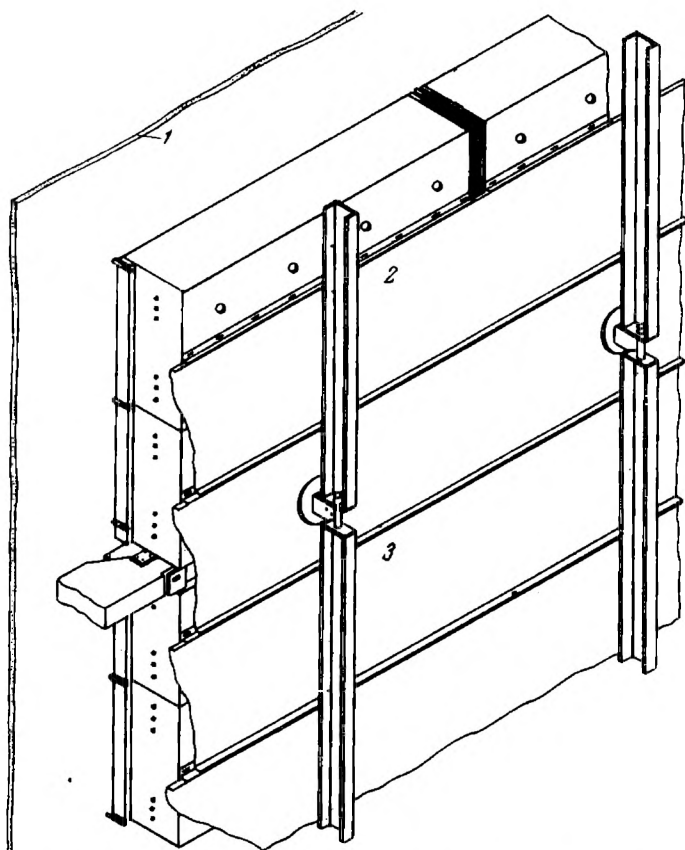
Схема вторичной оболочки и деревянных конструкций для закрепления первичных коробов:
